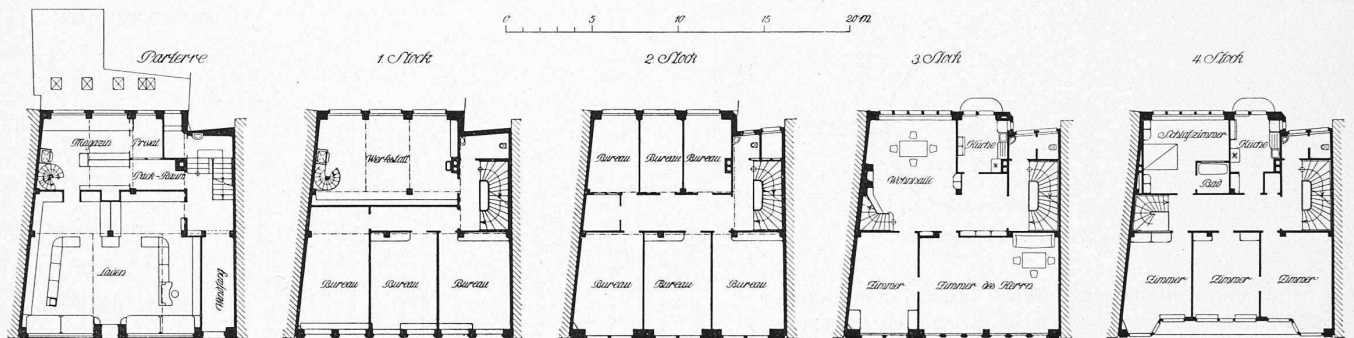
bis 5. Haus Walz in St. Gallen. — Grundrisse 1 : 400.
